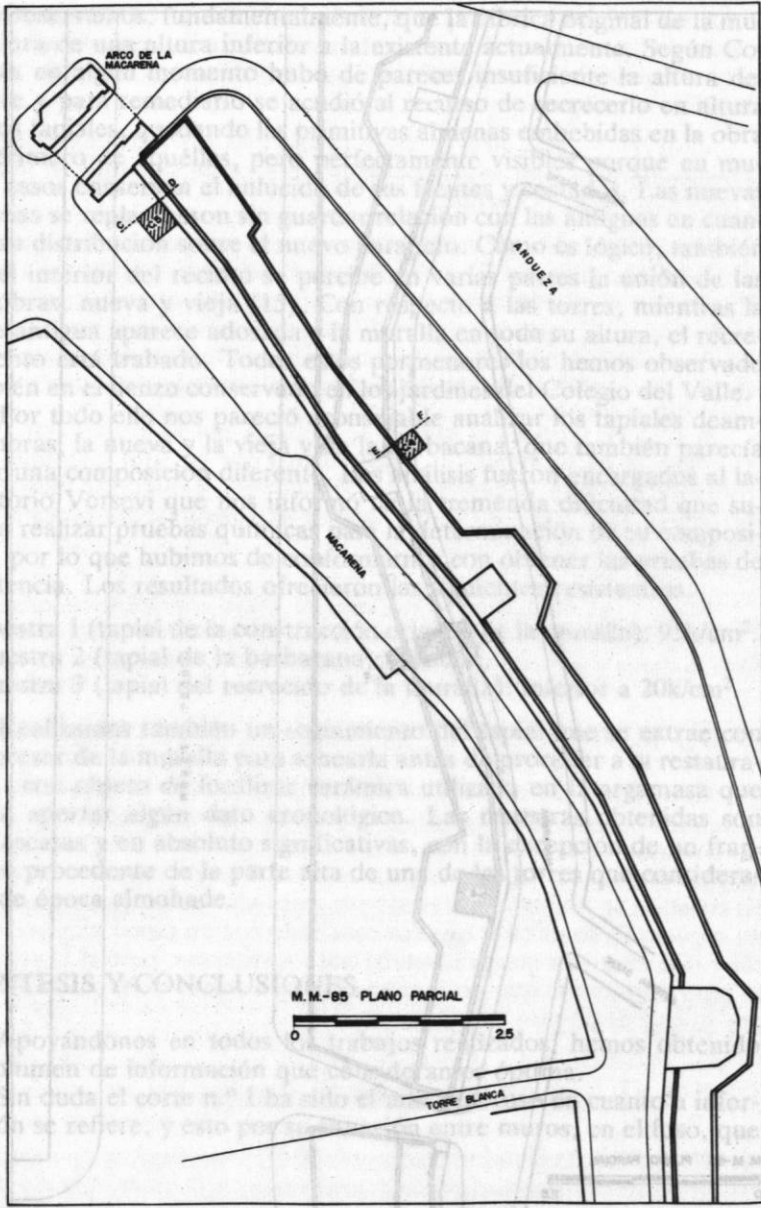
Plano parcial con la situación de los cortes 4 y 5.
